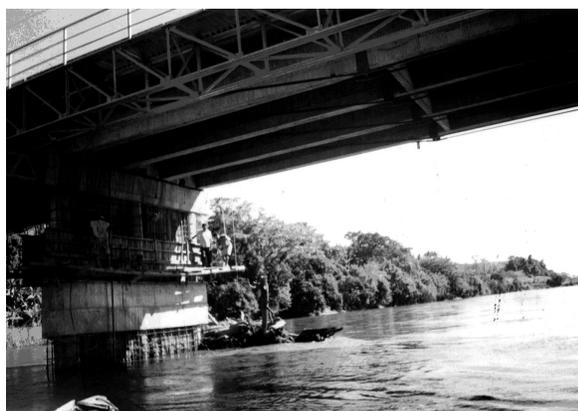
Reforzamiento sísmico de la pila. Puente Río Negro
